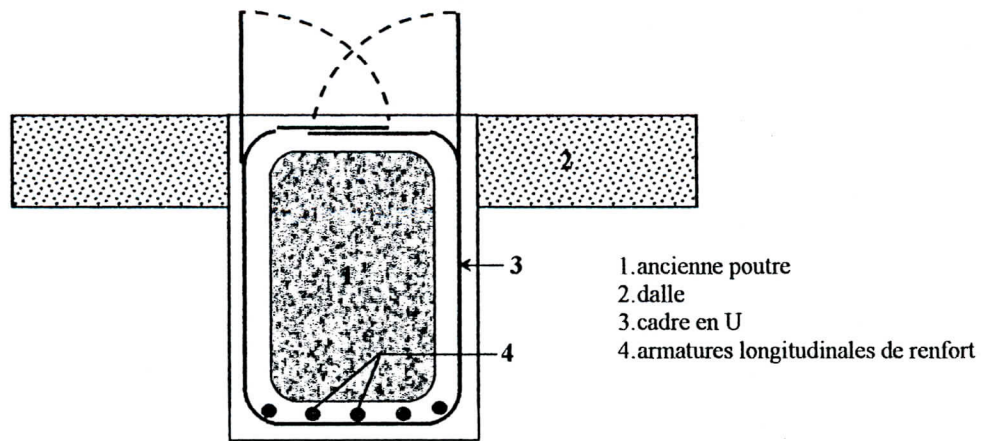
Renforcement des planchers par une sur-épaisseur en béton armé [2]
